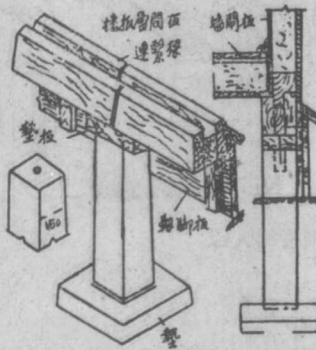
裝配式鋼筋混凝土柱式基礎，各種勒脚與開板的連接
